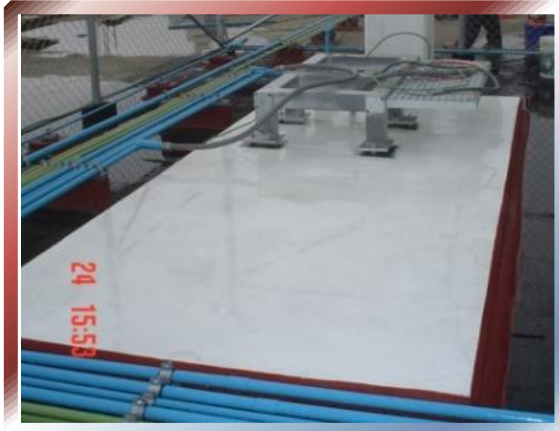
Base metálica y de concreto para equipos GSM
